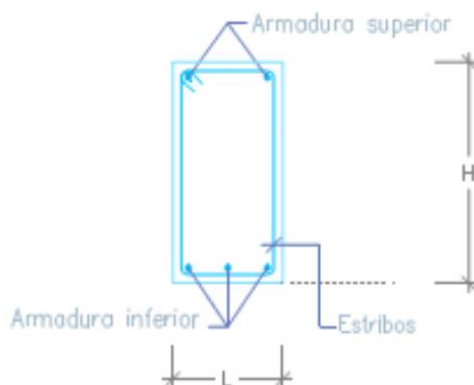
Corte representativo das armaduras detetadas nas vigas
